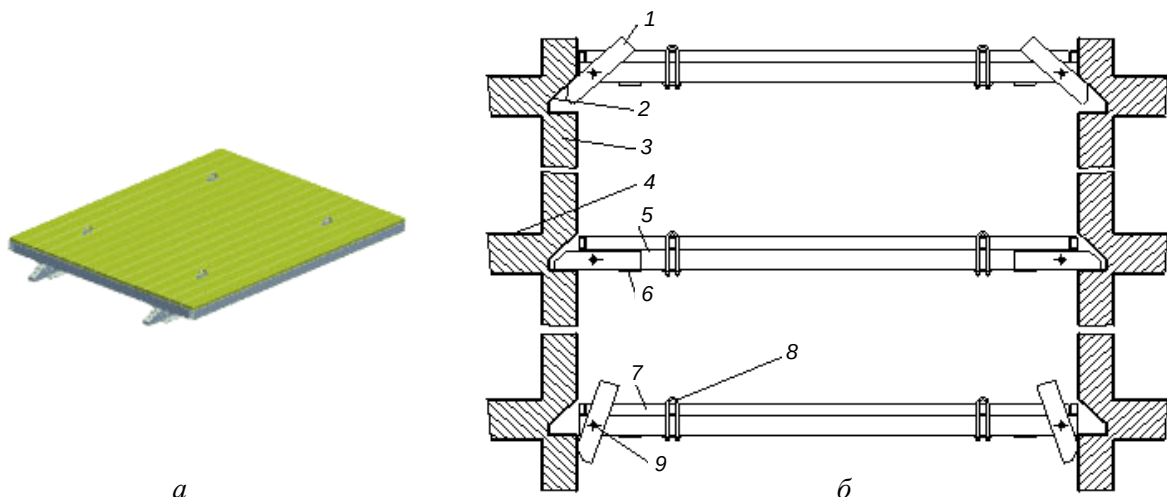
Алюмінієва опорна площадка для опалубки шахт:
